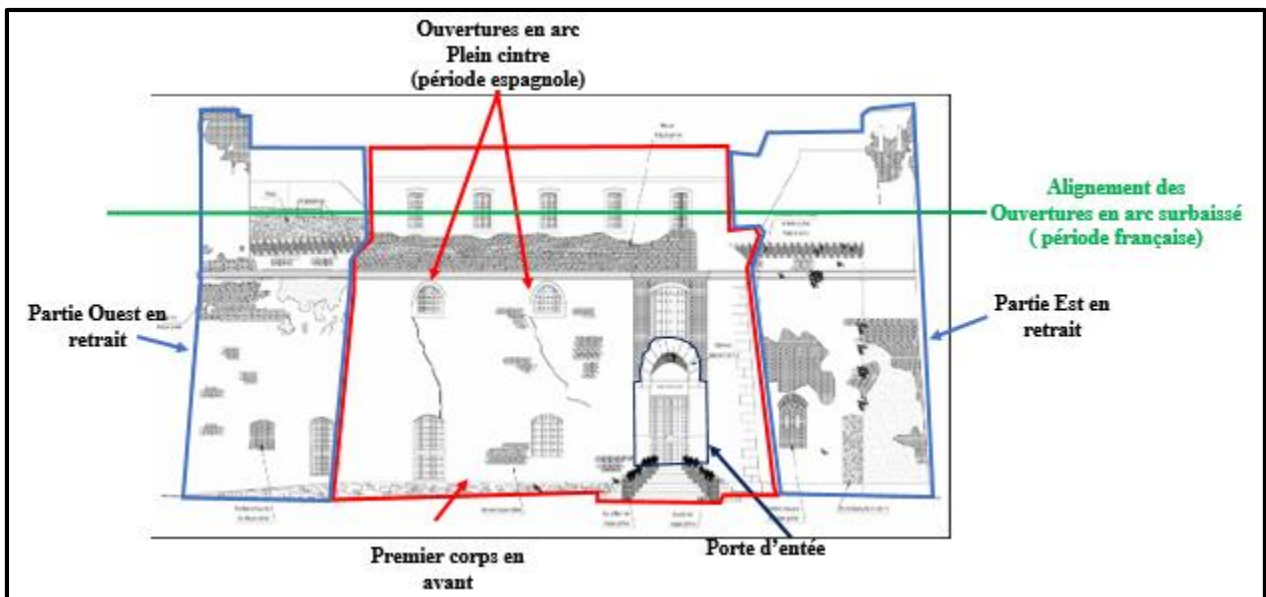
Façade sud de Bordj Moussa (Source : BET MAHINDAD, traitée par l'auteur 2025).
